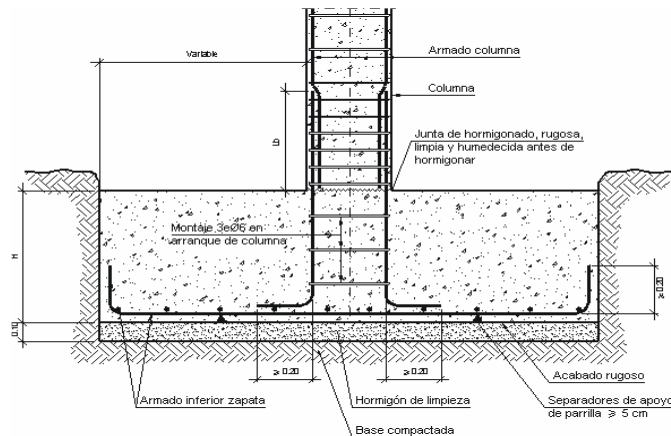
Cimentación de zapata aislada de concreto armado, imagen capturada por Francisco Reyes
